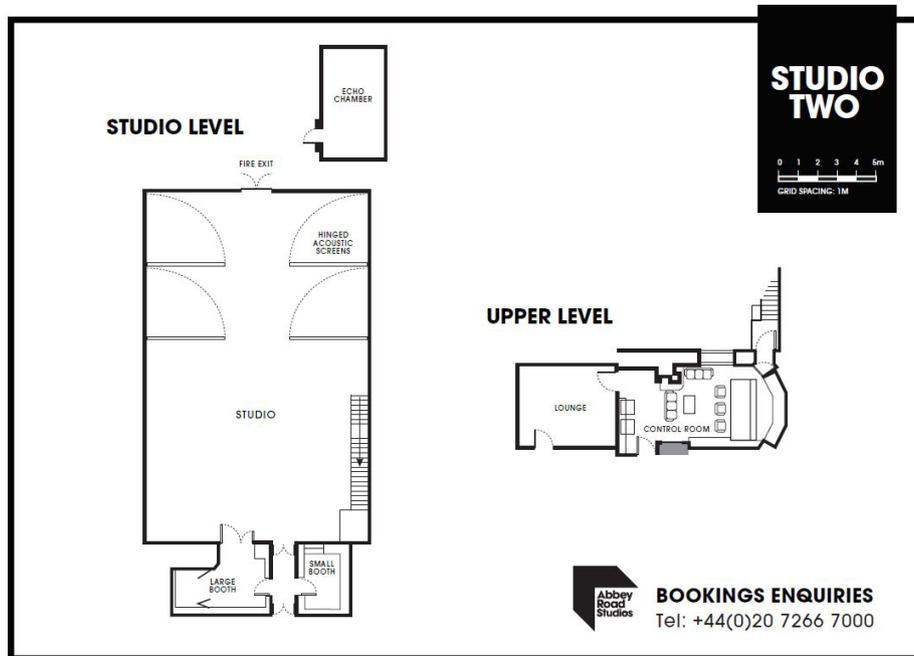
Planta Studio Two. Abbey Road (EMI). 2019
